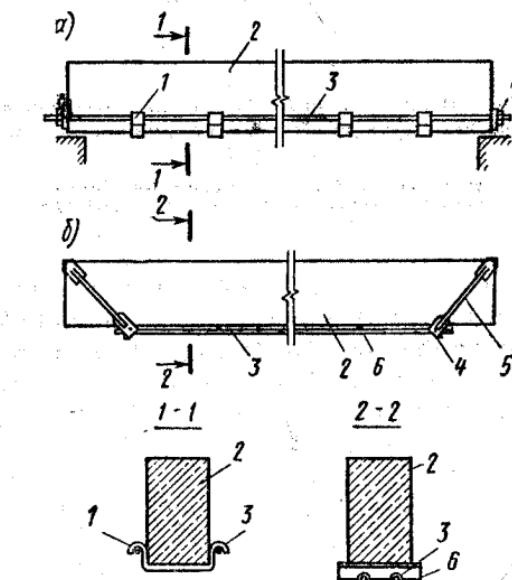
Усиления балок предварительно напряженной арматурой:
